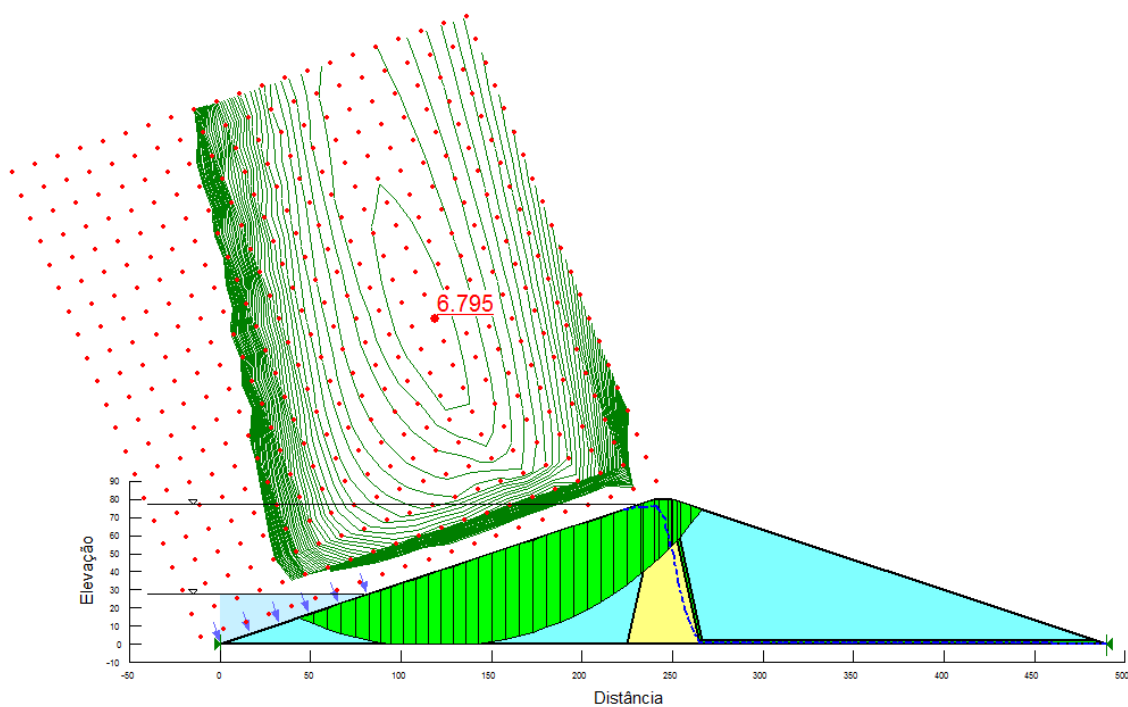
Fator de segurança e círculo de ruptura da barragem de enrocamento com núcleo argiloso de 40 m de comprimento para a condição de rebaixamento instantâneo.
